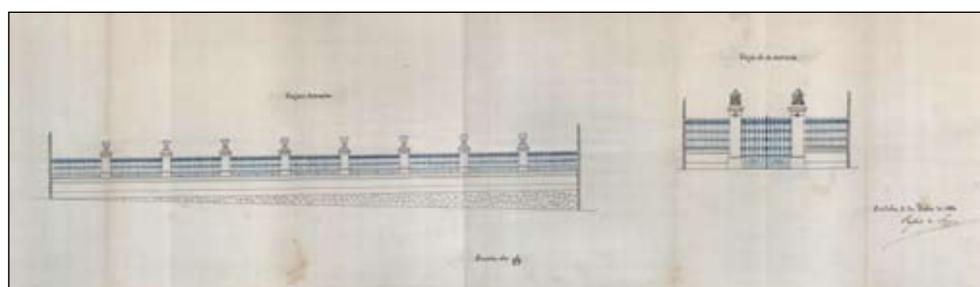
Planos de verjas de entrada y verjas laterales del proyecto.
